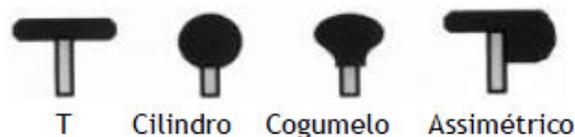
Exemplos de terminações de barreiras, adaptado de [26]
